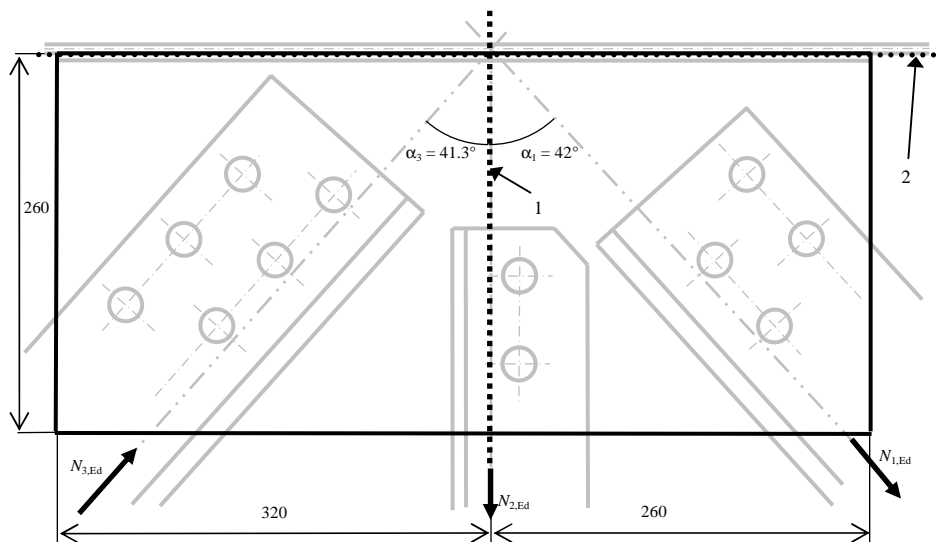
Ubicación de las secciones transversales netas de la cartela
